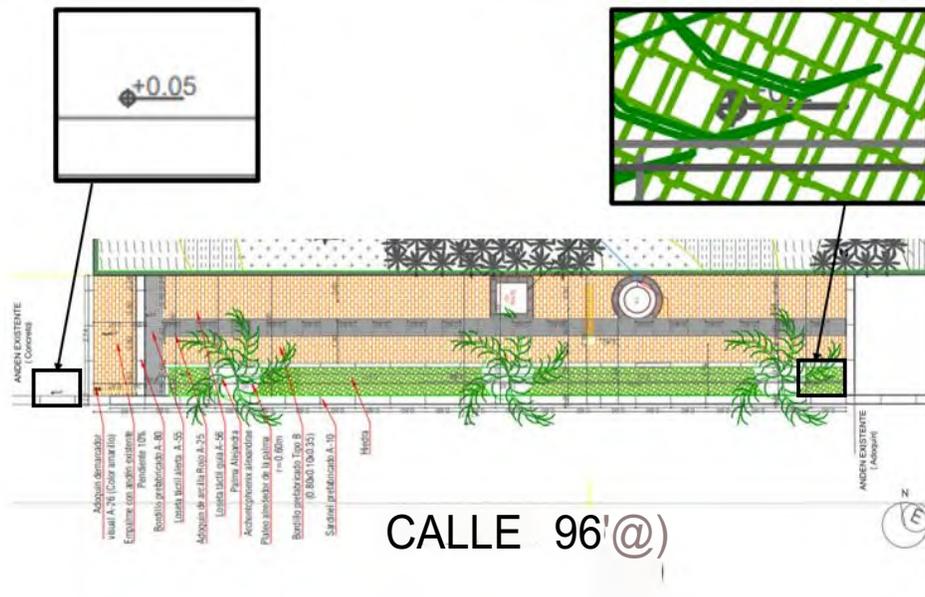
Planta de diseño Calle 96 indicando el área de detalle que precisa el nivel
